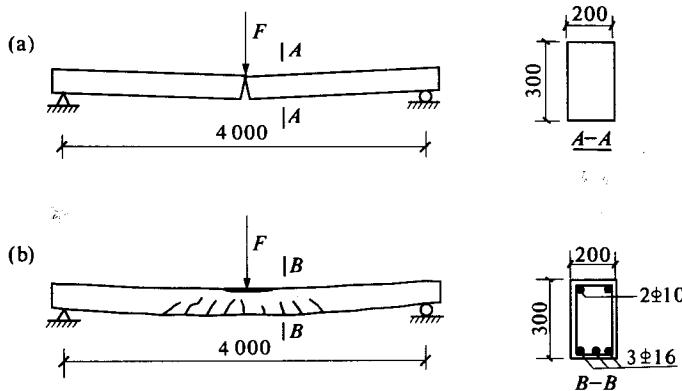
素混凝土简支梁与钢筋混凝土简支梁破坏情况对比
